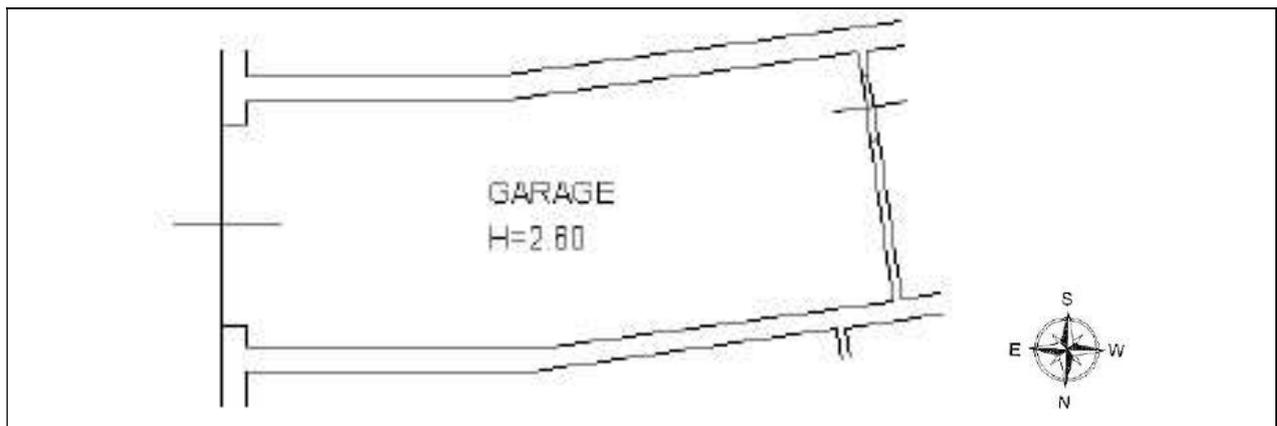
Estratto planimetria catastale Part. 883 sub. 20 -piano seminterrato
